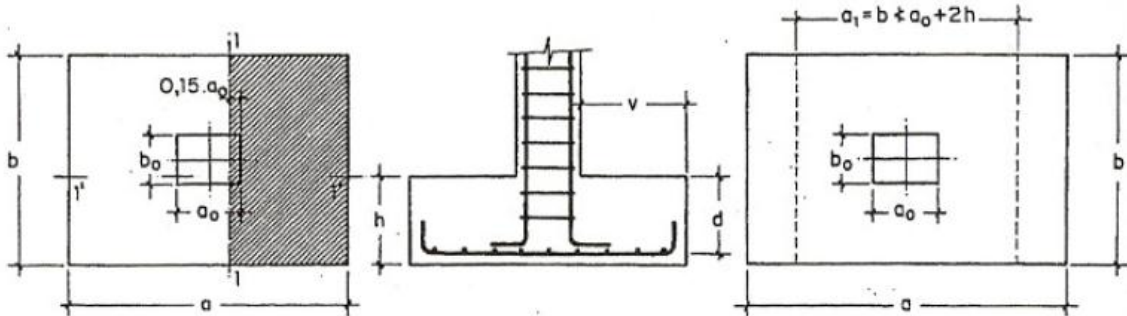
Armadura de tracción en zapata aislada, Montoya-Meseguer-Moran
